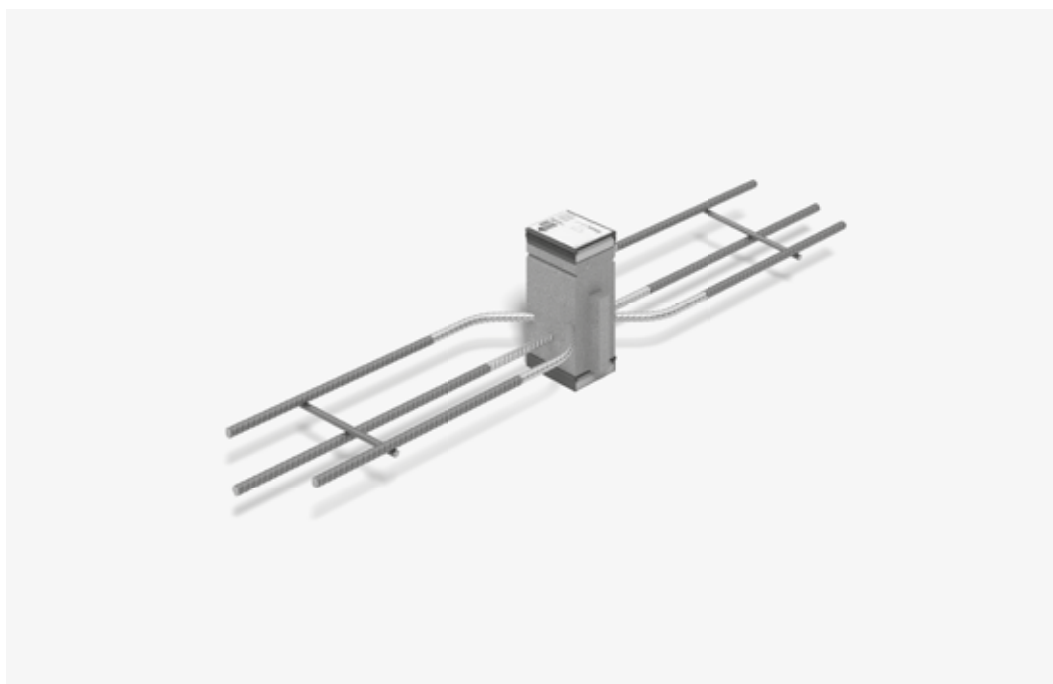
Schöck Isokorb® T tip DL: strop iz elementov s postavljenimi Isokorb® T tip DL
